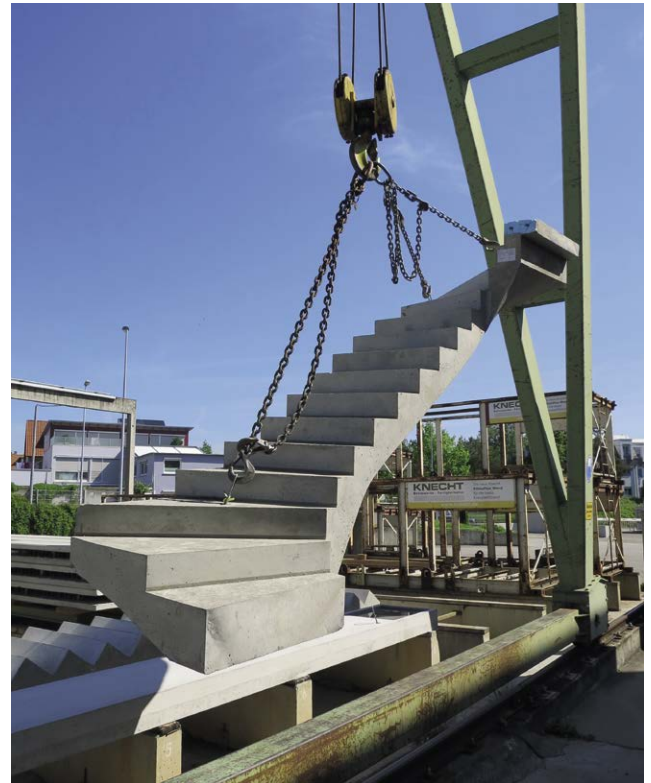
Betonfertigteiltreppen sind direkt nach der Montage begehrbar.
